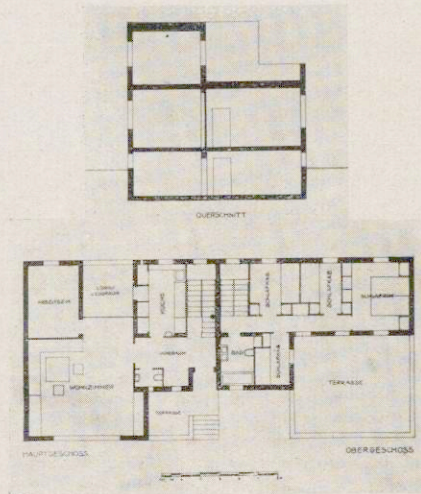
Grundrisse und Schnitt, Reihenhäuser II. S. Abb. 12, 13, 14 u. 15
